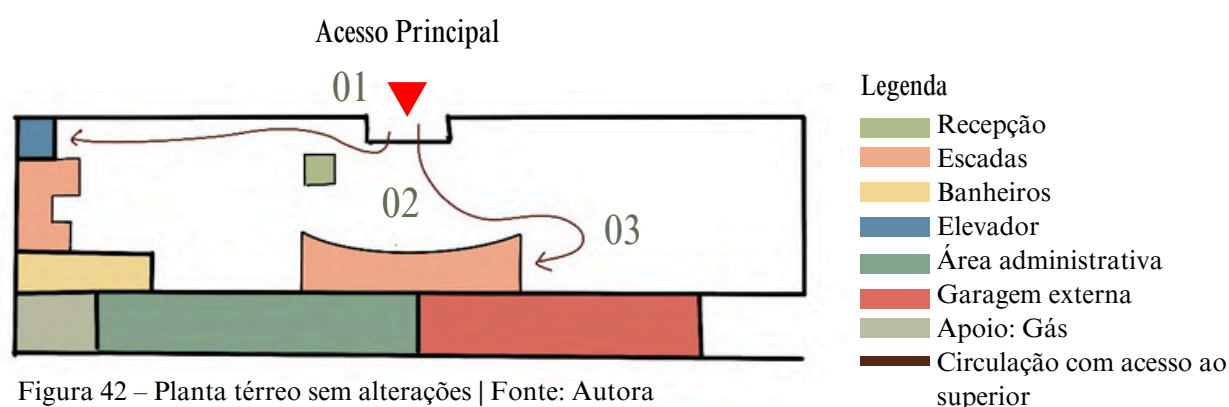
Planta térreo sem alterações | Fonte: Autora
